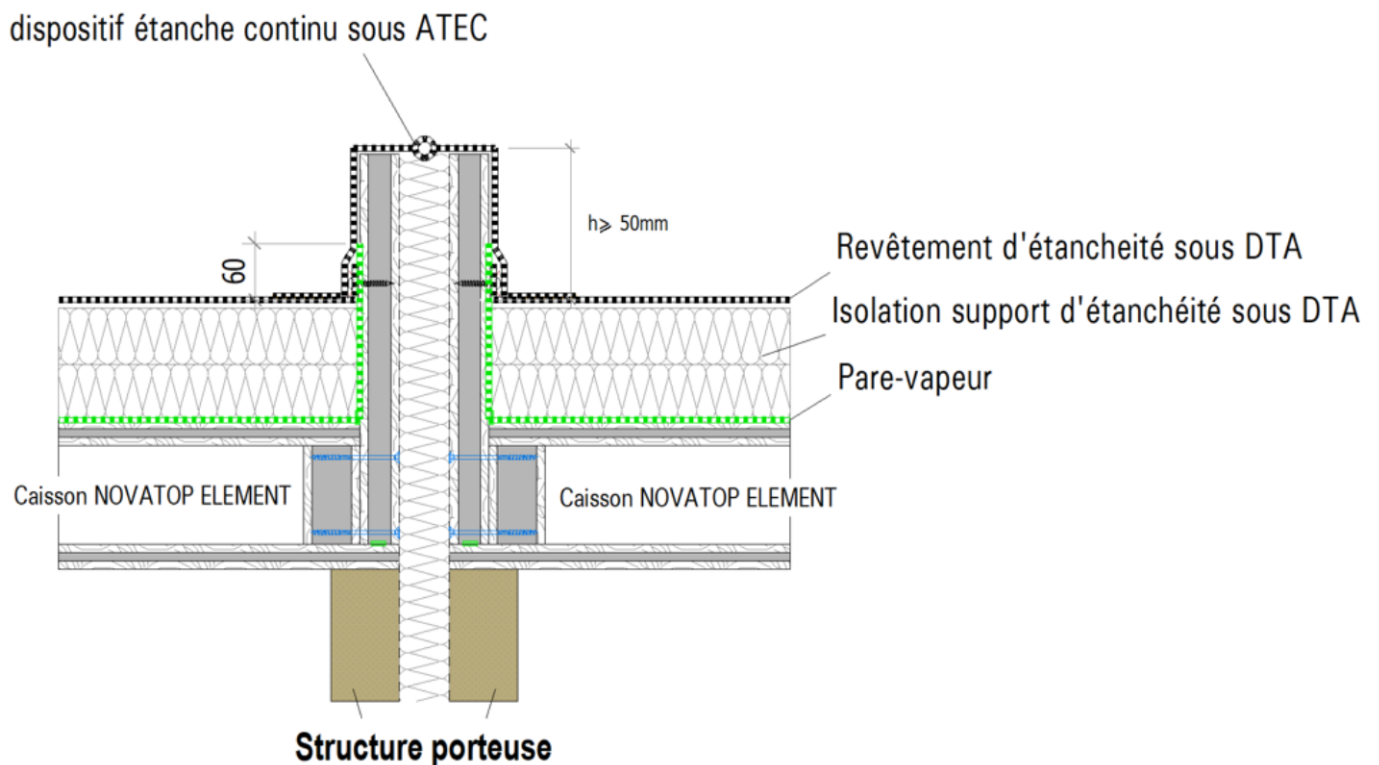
B – Joint de dilatation selon DTA du revêtement d'étanchéité (terrasse inaccessible)
